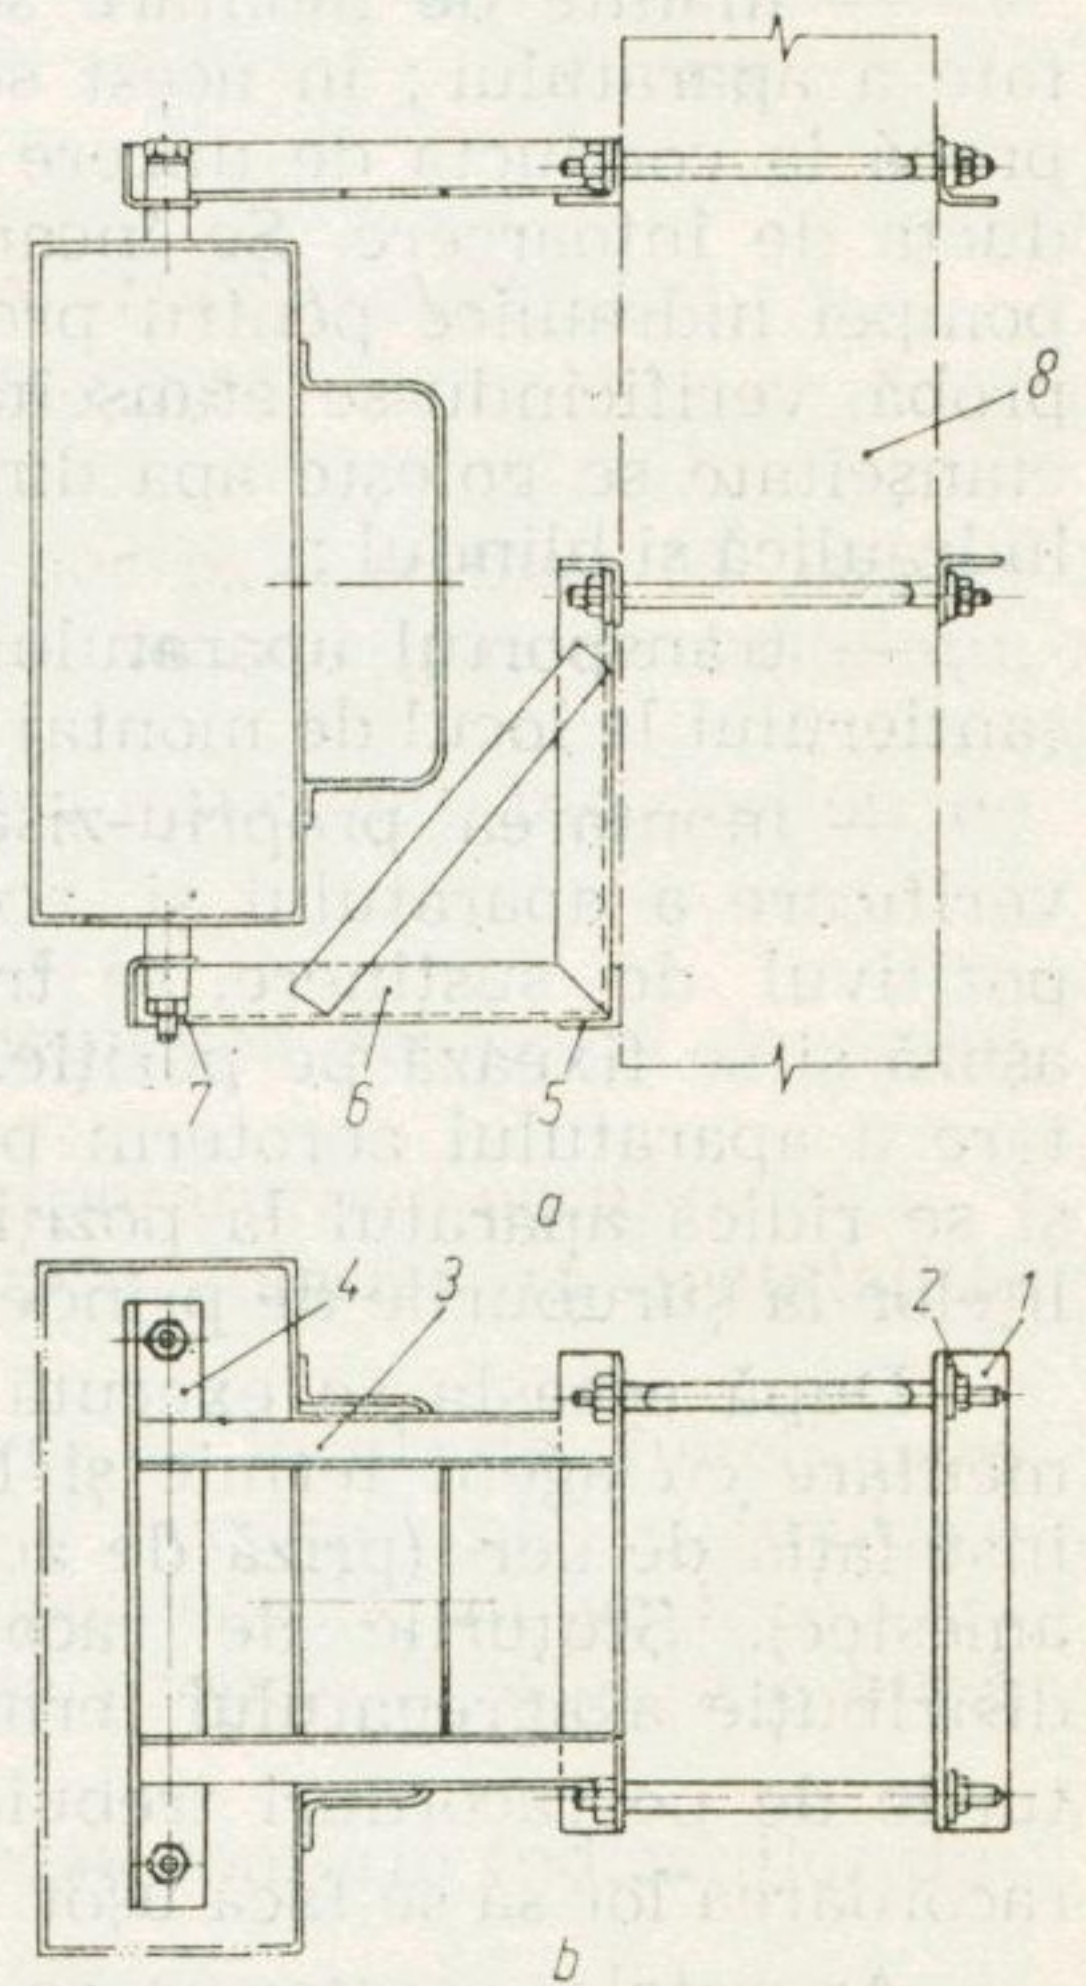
Suport tip jug pentru aérotermă montată pe stîlp de beton :
